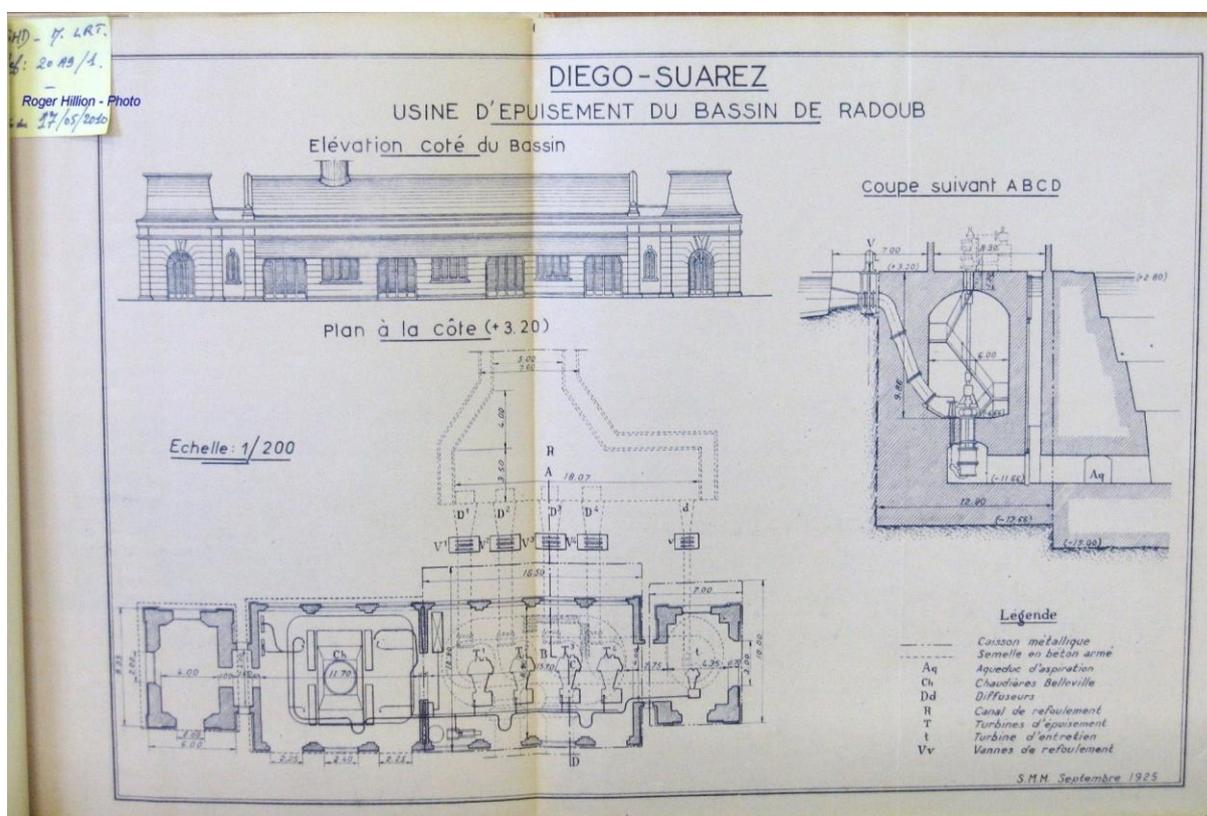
Plan : Usine d'épuisement – Coupes transversale et horizontale (Archives SHD Lorient)
